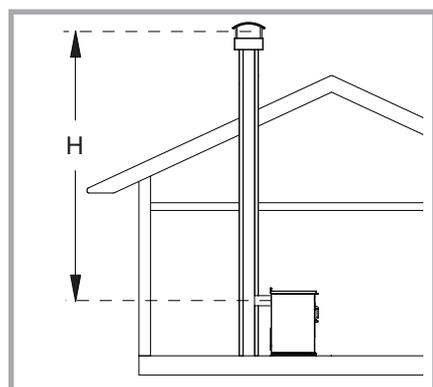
Maß H für Bemessung des Rauchabzugsrohrs
